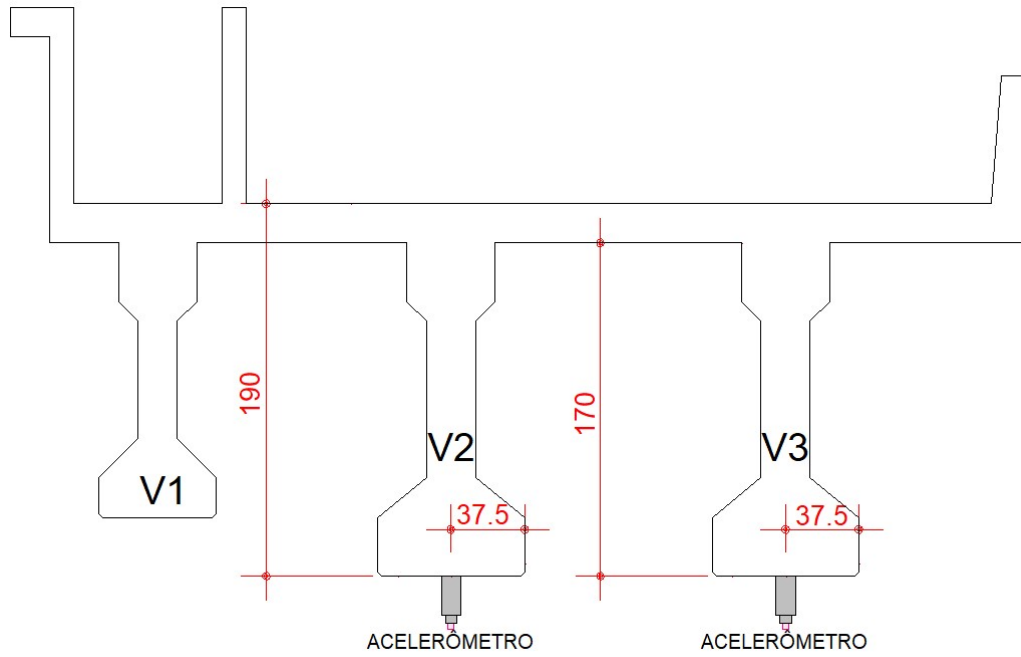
Posicionamento dos acelerômetros nas seções transversais das longarinas (dimensões em centímetros).
